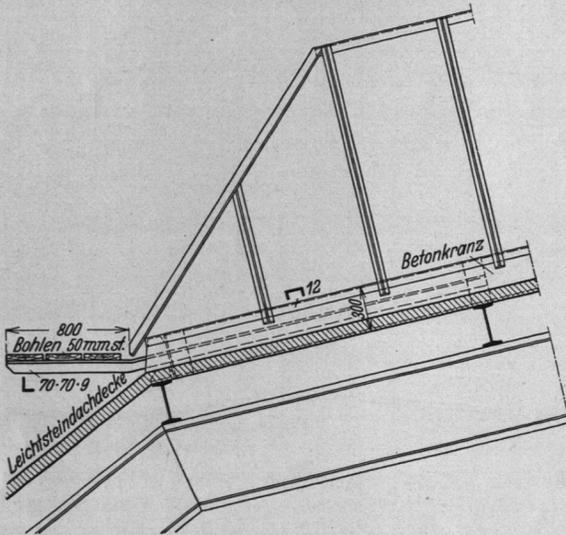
Laufsteg vor einem bis zur steileren Dachfläche durchgehenden Oberlicht.
